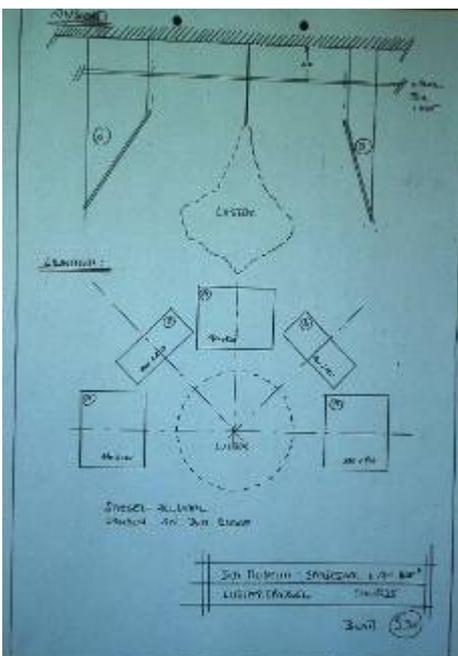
, Entwurf R. Langenfass, Ansicht und Grundriss der zentralen Lichtinszenierung
